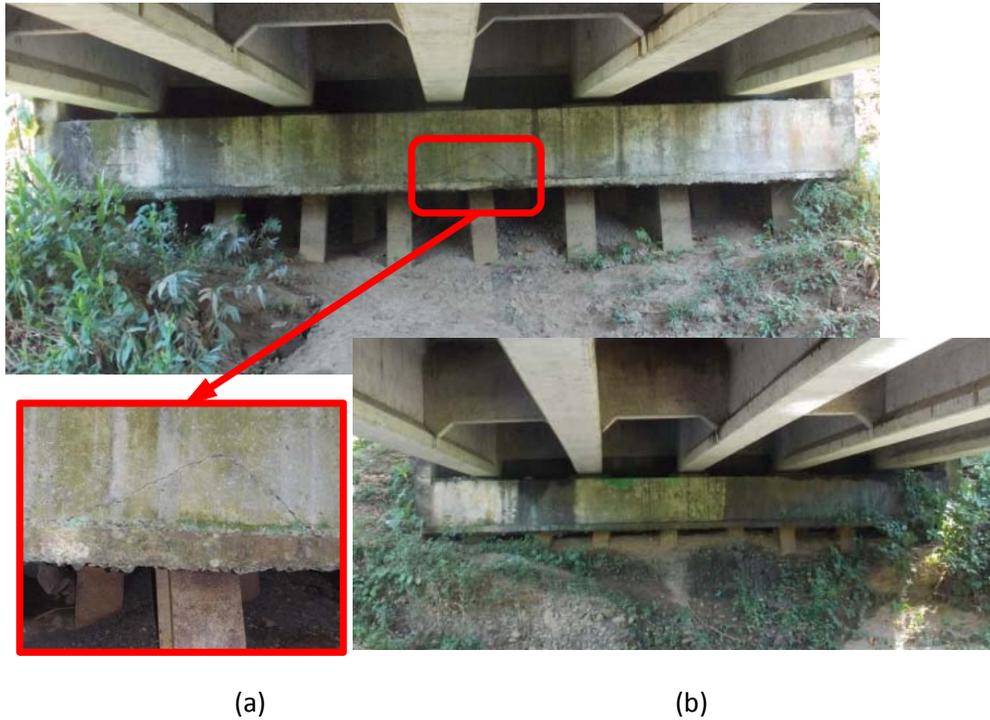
Manchas de humedad y socavación de las cimentaciones: (a) Bastión B1 con detalle de grieta en conexión pilote-bastión; (b) Bastión B2.
